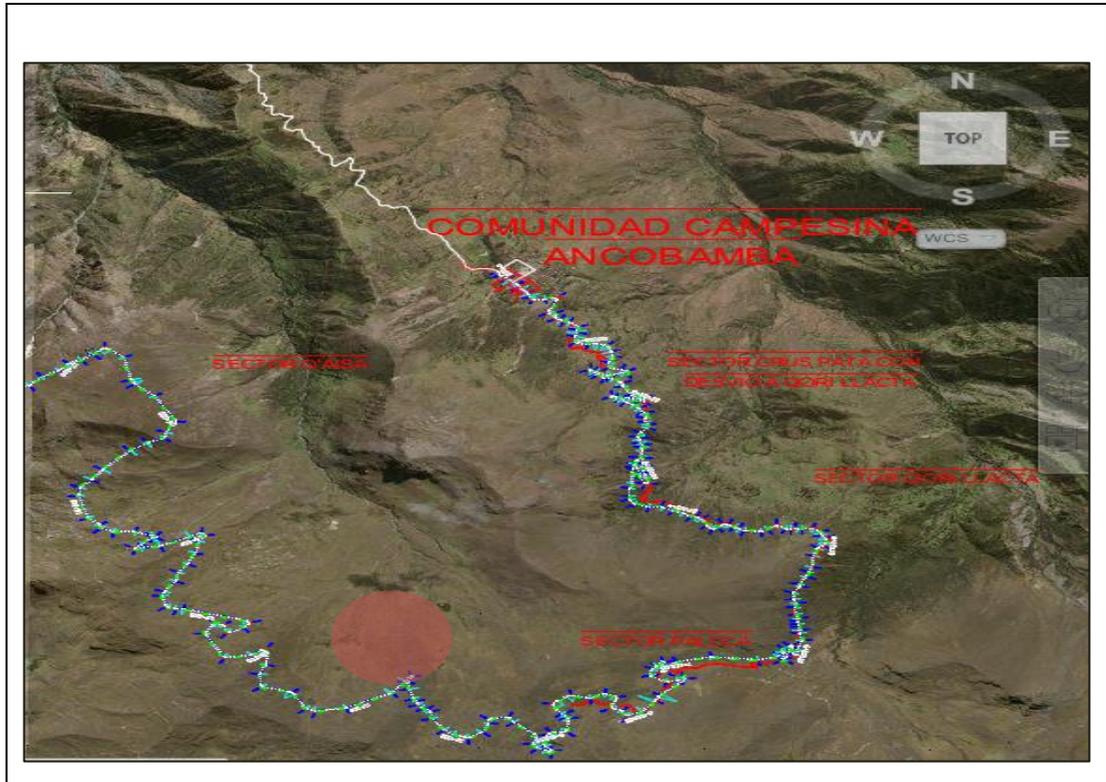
Ubicación de la plantación en el sector Ccaysa Pampa.
